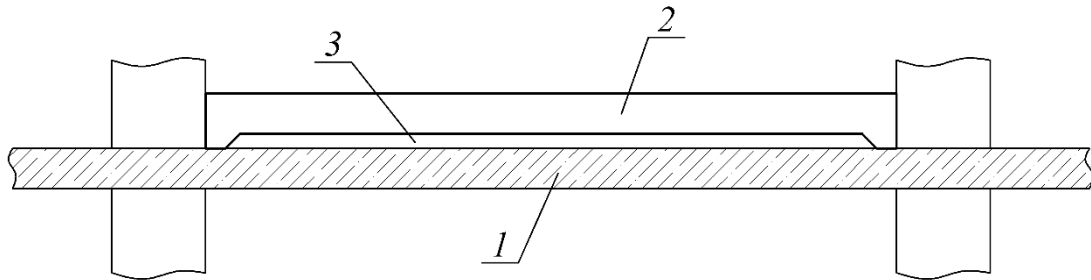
Полное разгружение перекрытия железобетонной конструкцией
